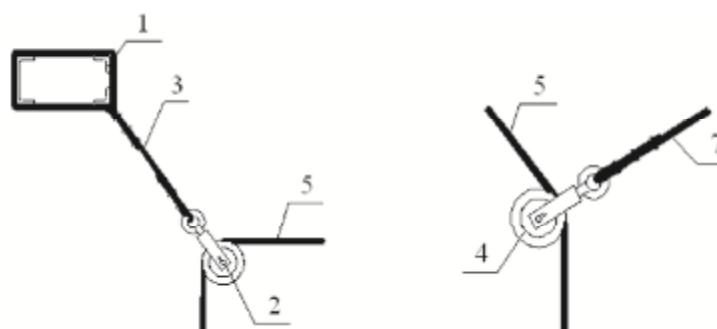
Узлы монтажной системы: 1 – элемент каркаса градирни; 2 – отводной монтажный блок; 3 – обводной трос; 4 – монтажный блок; 5 – грузоподъемный канат; 7 – оттяжка
